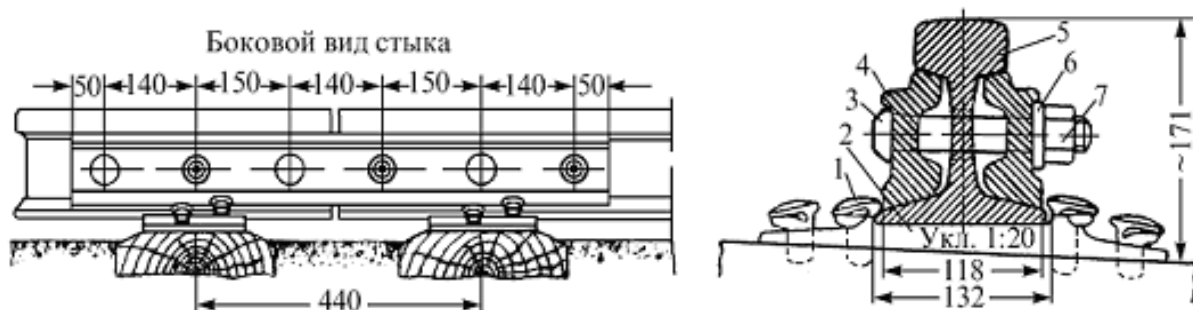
Рельсовый стык: 1 – костыль; 2 – подкладка; 3- болт; 4 – накладка; 5 – рельс; 6 – шайба; 7 - гайка
